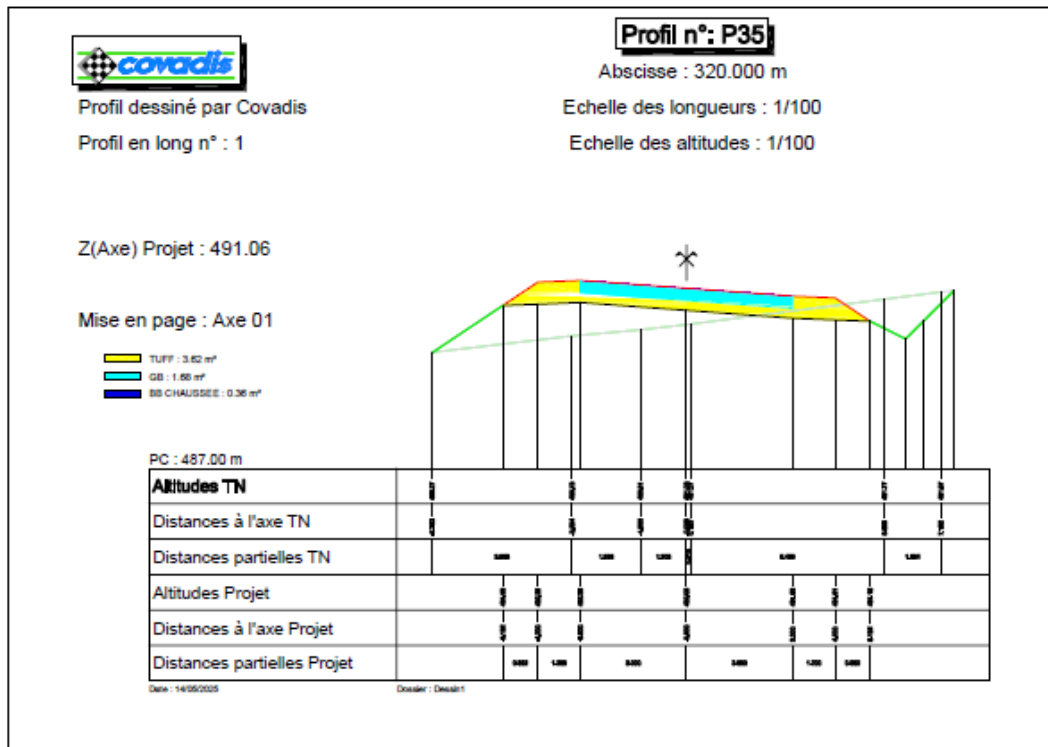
Exemple d'un profil mixte cas de notre projet
